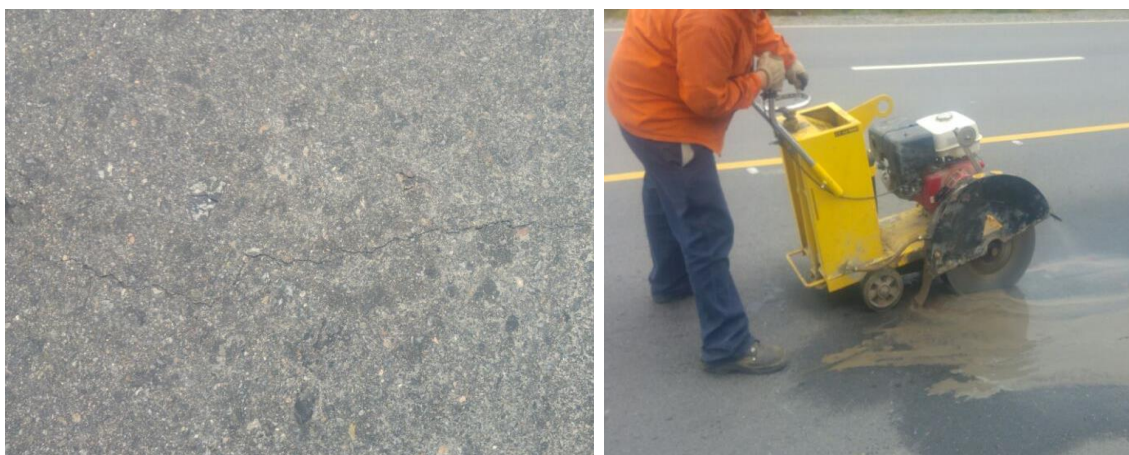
Ejecución del Dren- a) Fisuras en el Pavimento, b) Aserrado de la Carpeta de Rodamiento
